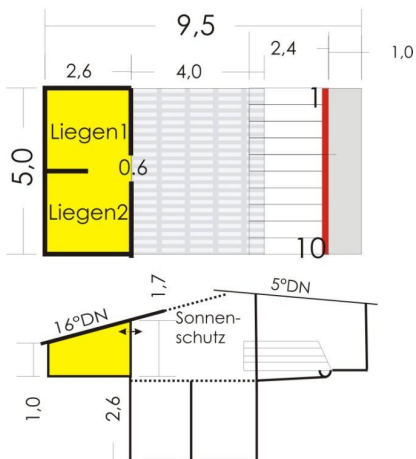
Grundriss und Schnitt von Hüttenhaltung mit Güllekeller.
